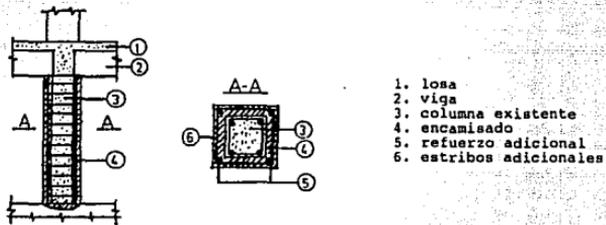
Encamisado de columnas a base de concreto reforzado.
